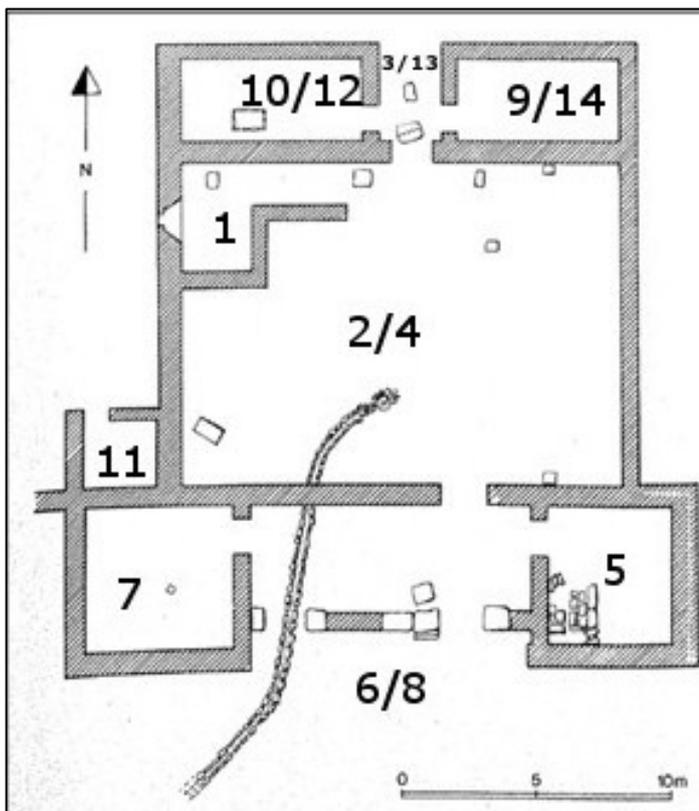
Grundriss der Villa 1961 mit der, im Text verwendeter Raumnummerierung.
